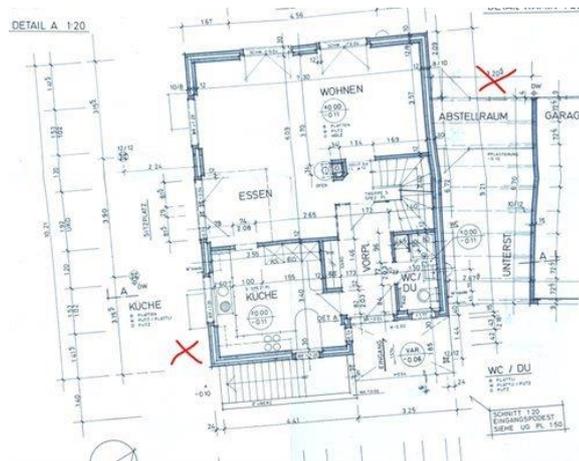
Grundriss mit potenziellen Standorten
